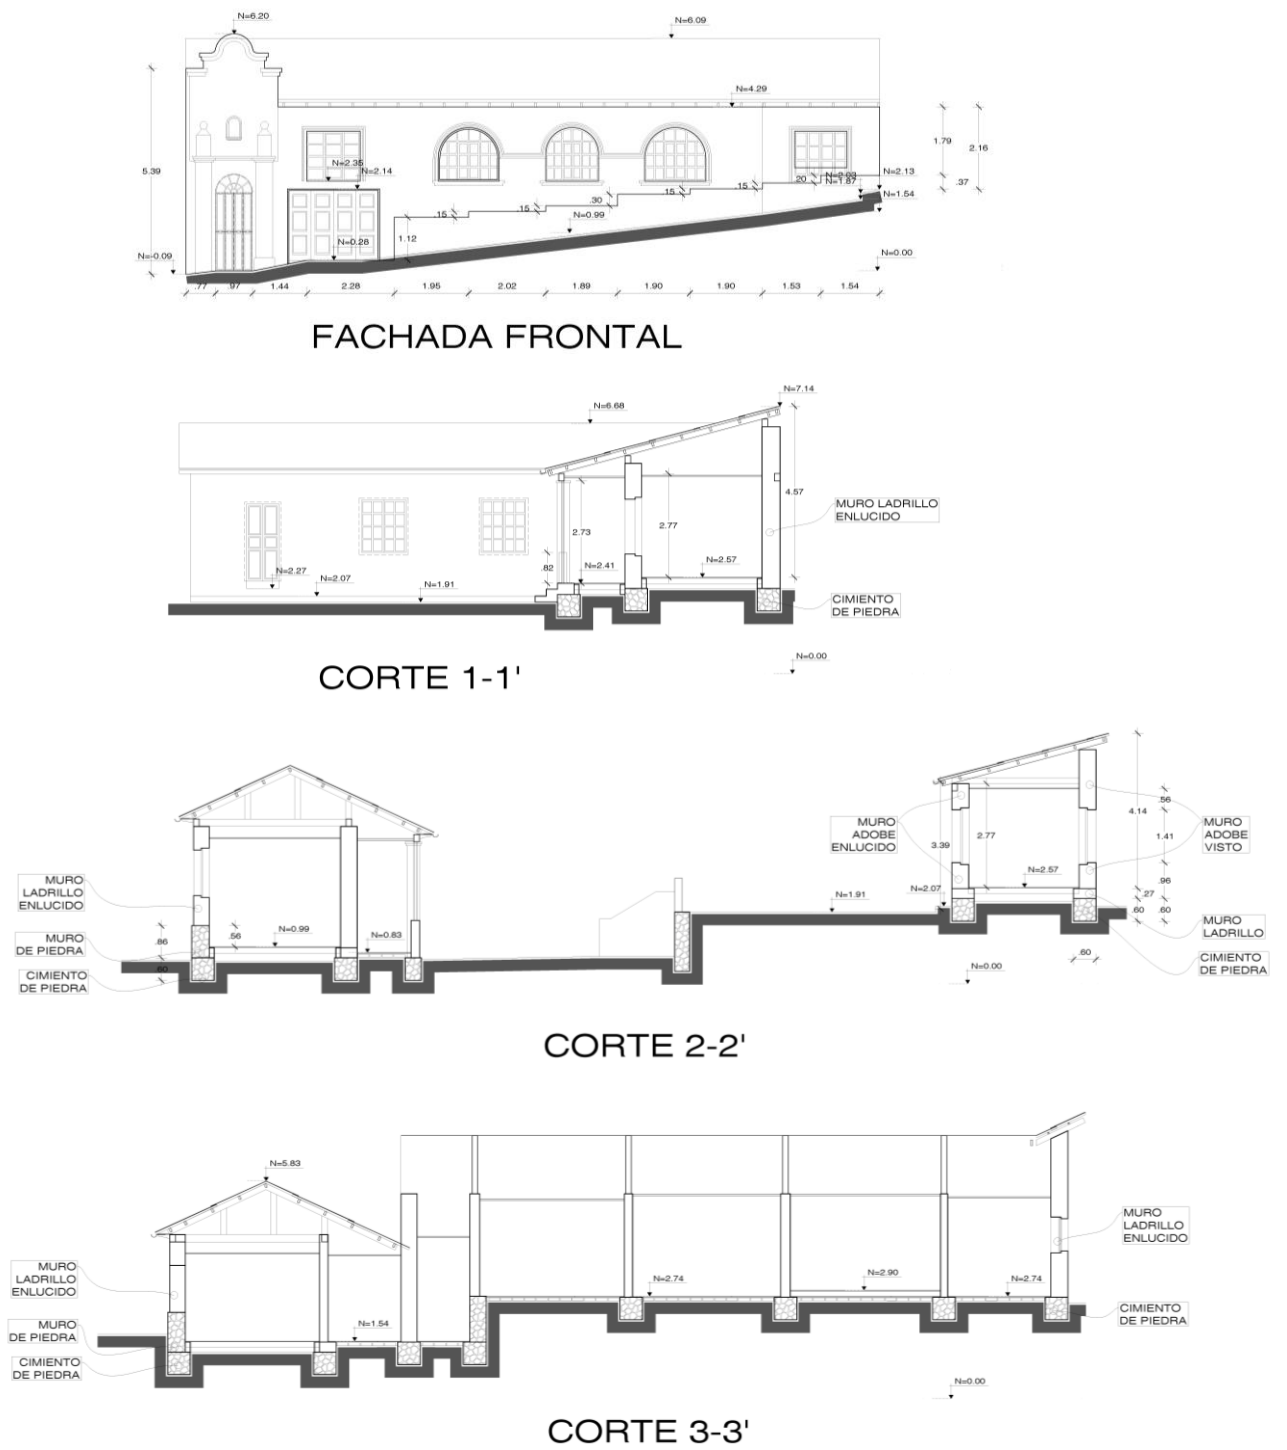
Fachada principal y cortes inmueble existente. Elaboradas por (Cabezas I., 2017)
